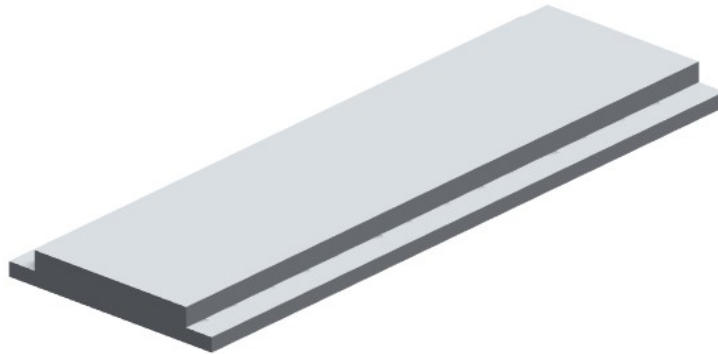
Isometri Model *Redesign Half Slab* Tipe – 1C
